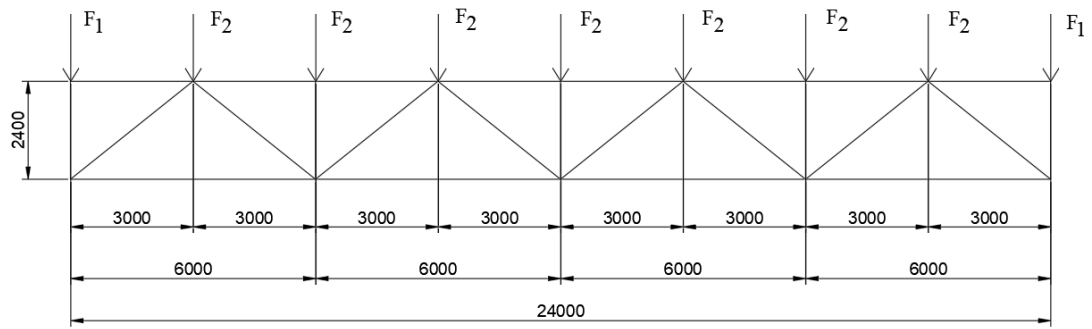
Розрахункова схема ферми прольотом 24 м
